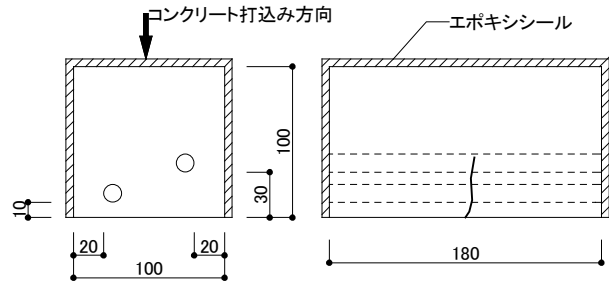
非貫通ひび割れ試験体(試験体タイプB)
